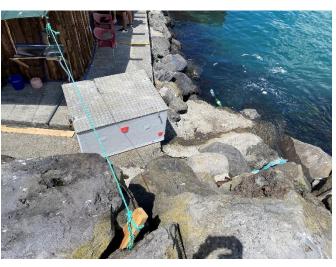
Zona da descarga da caleira (para onde estão ligadas as tubagens de todas as pias instaladas nas três tascas instaladas no porto).
